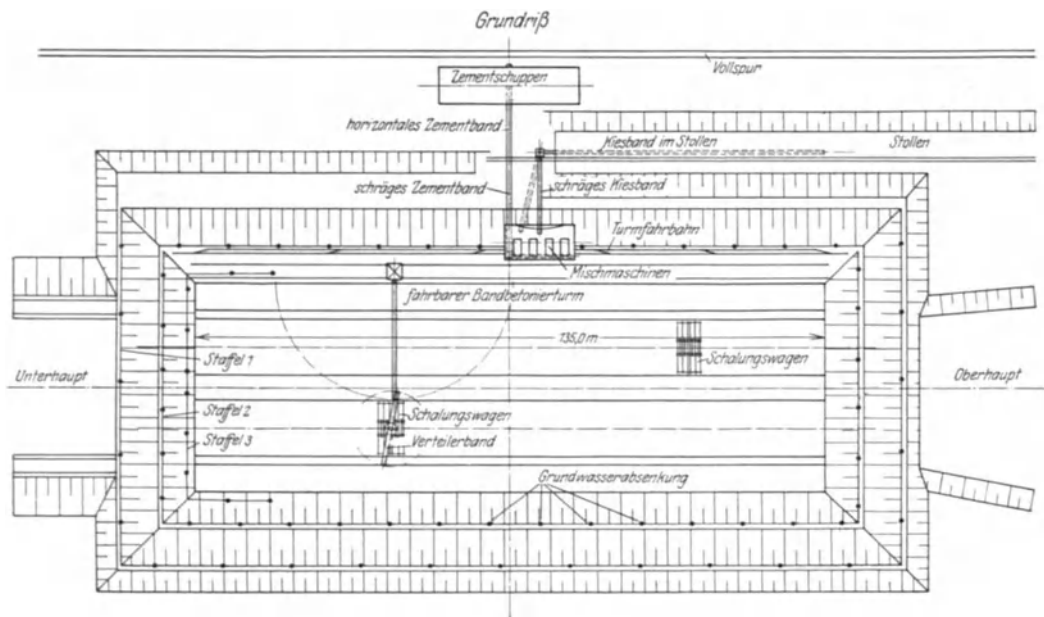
Lageplan der Schleuse Ladenburg mit Baustelleneinrichtung.
